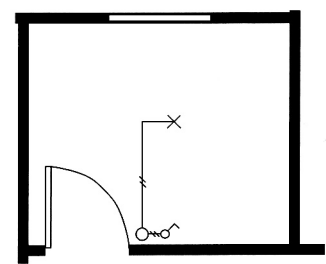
Esquema unifilar simplificado en planta de edificio.
